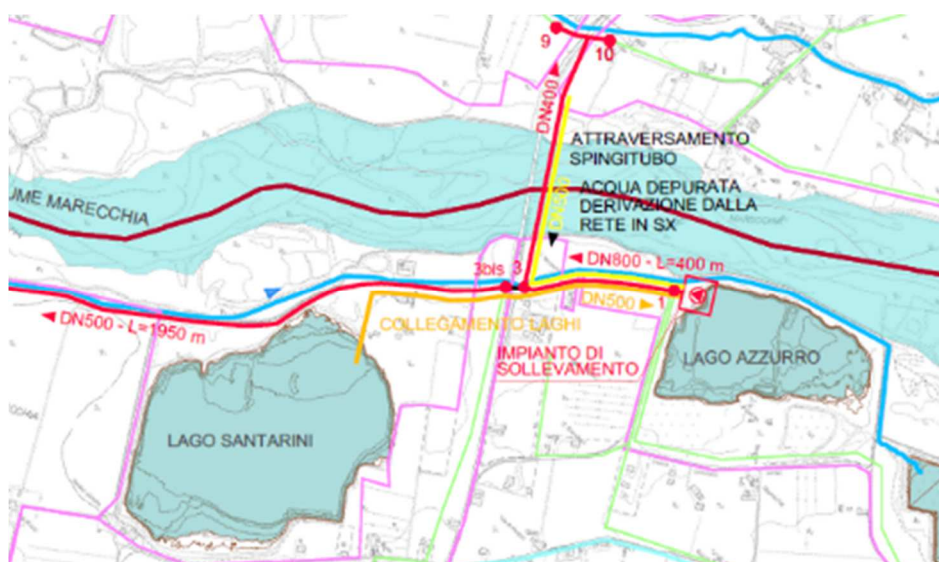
Planimetria di progetto dei laghi del Progetto Definitivo
